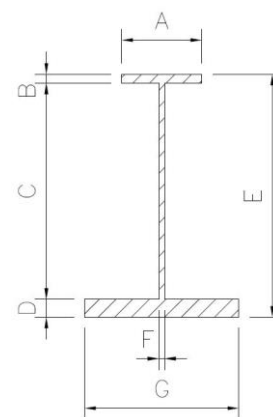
Características Geométricas dos Trechos Centrais (11,70 metros) da Viga Metálica sem Laje de Colaboração em Concreto Armado.
